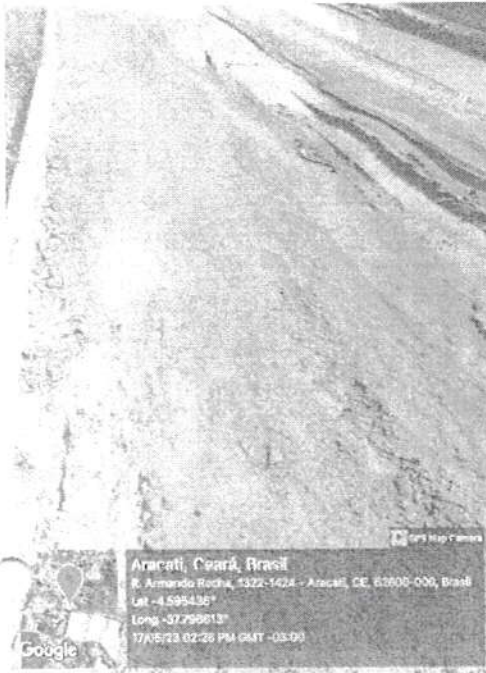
No trecho é possível notar o desgaste completo da pavimentação asfáltica local.
